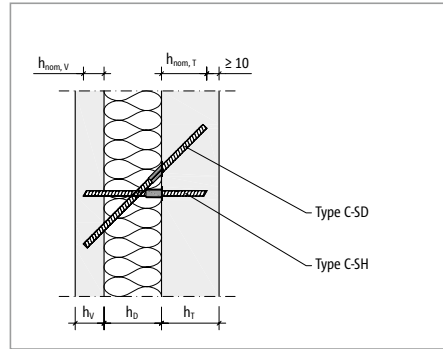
Schöck Isolink® type C-SH, C-SD : données de la section du mur sandwich ;  $h_{nom,V} < h_V$
